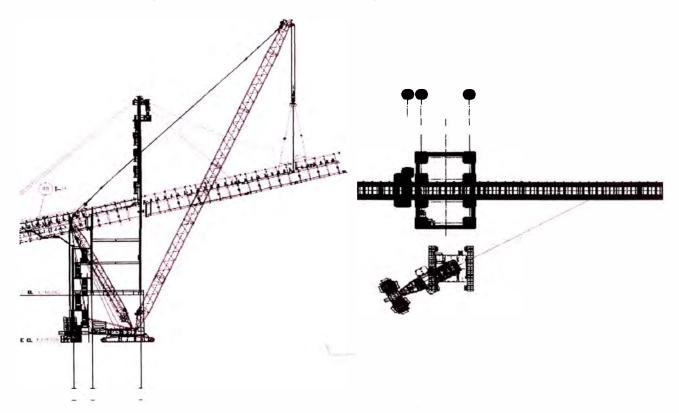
Ubicación de grúa LR 1400-2 montaje de secciones 3&4
